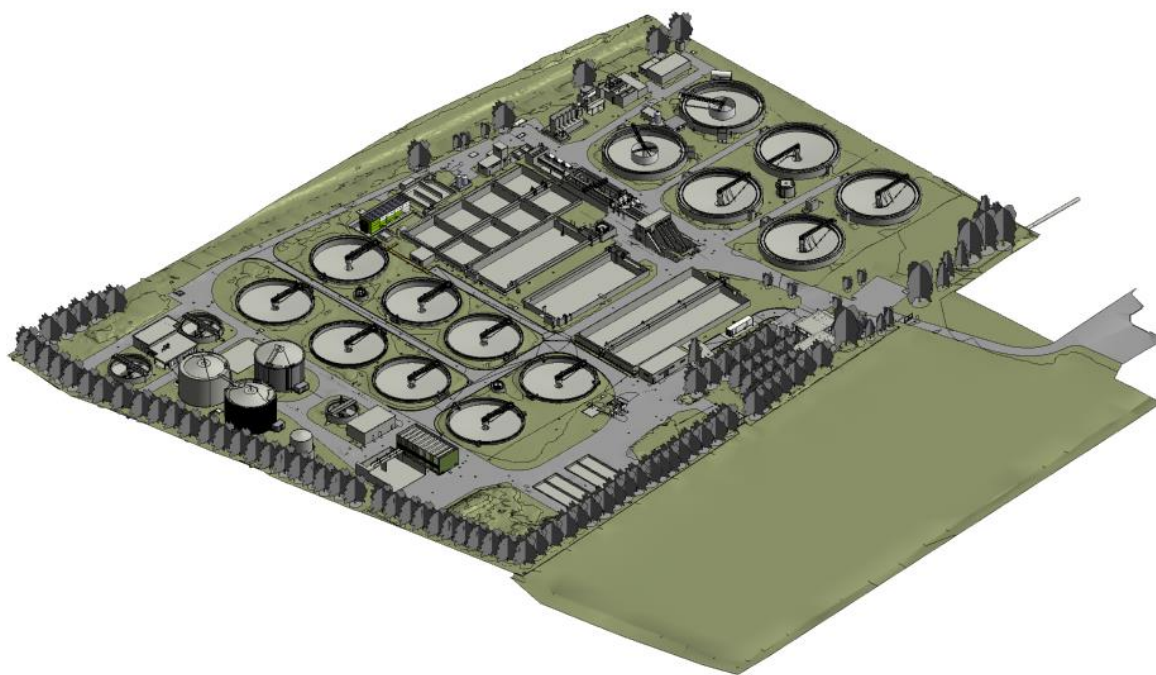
Modello tridimensionale stato di fatto impianto di depurazione di Ravenna
